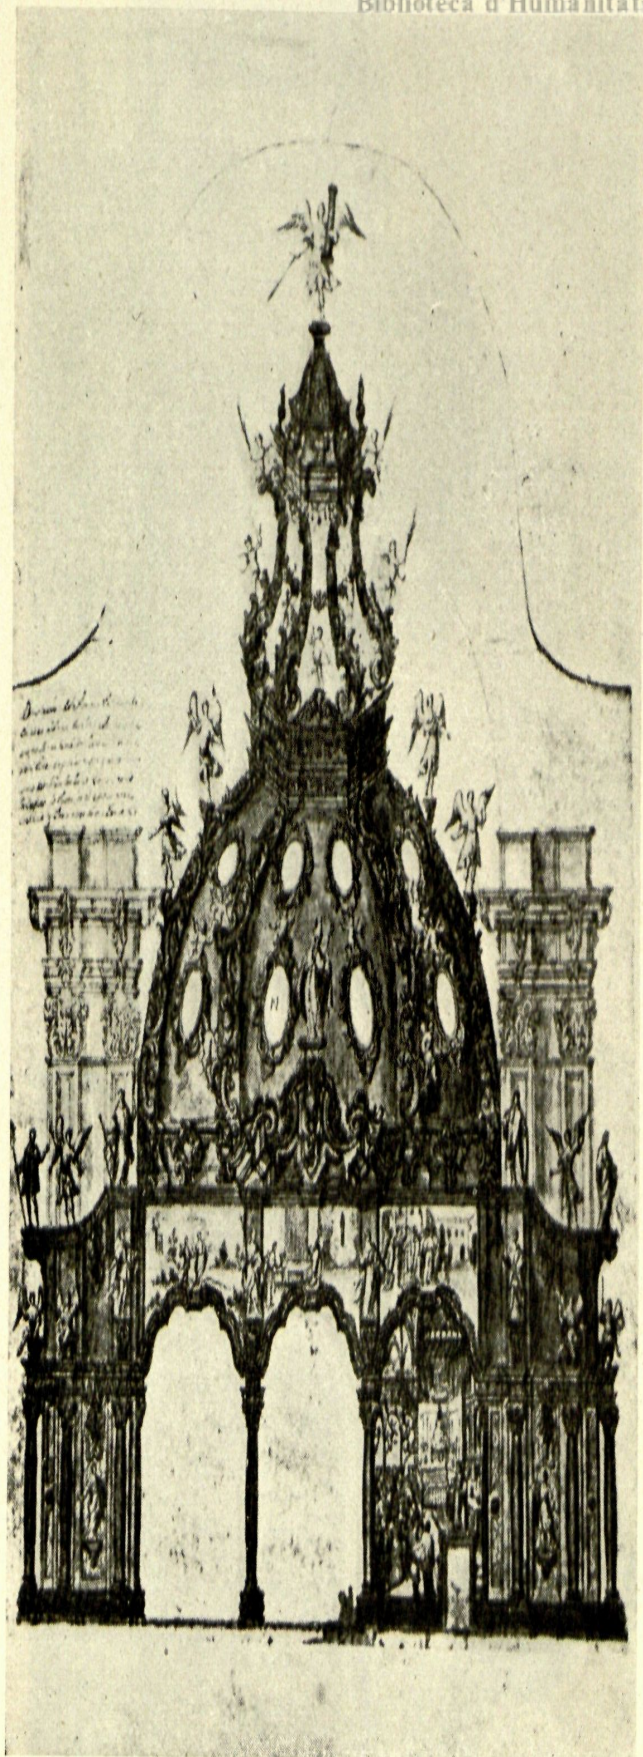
Proyecto anónimo para la Santa Capilla del Pilar.
